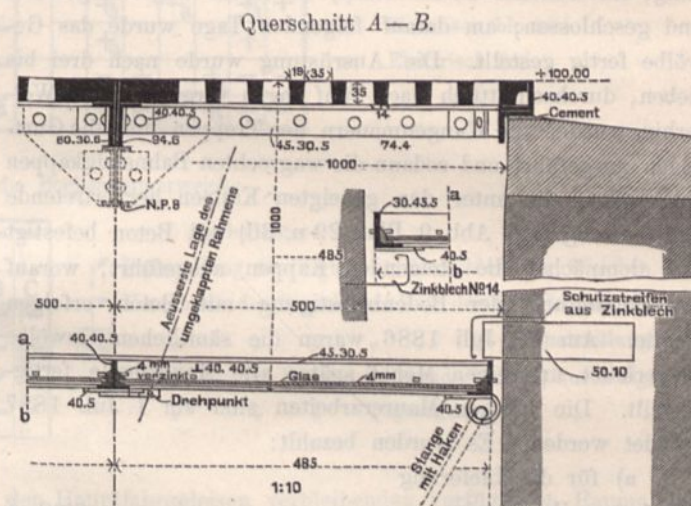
u. 54. Grundrisse und Schnitte der Oberlichter in den Personen- und Gepäckbahnsteigen.
